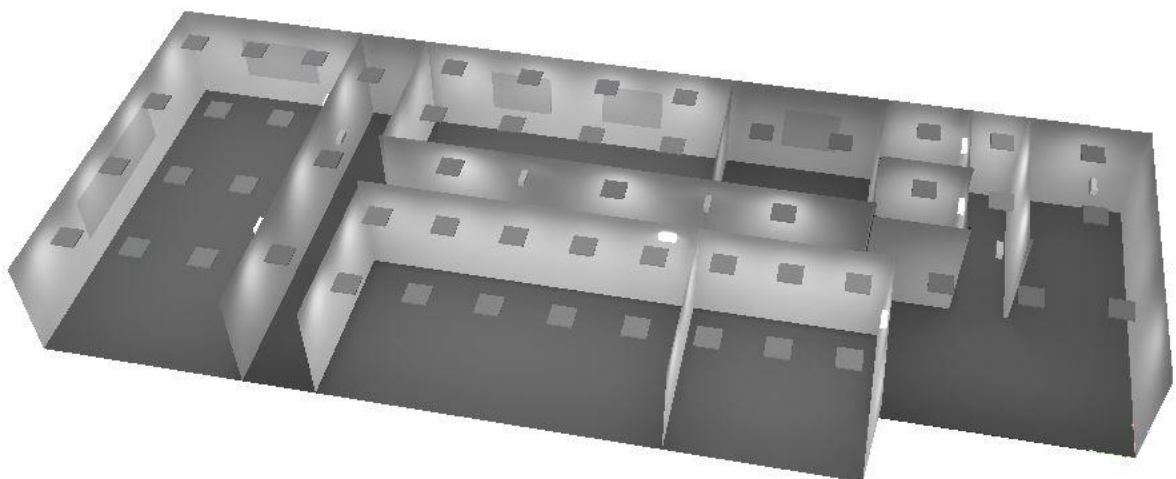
Vista 3D de la iluminación en la Planta Alta
